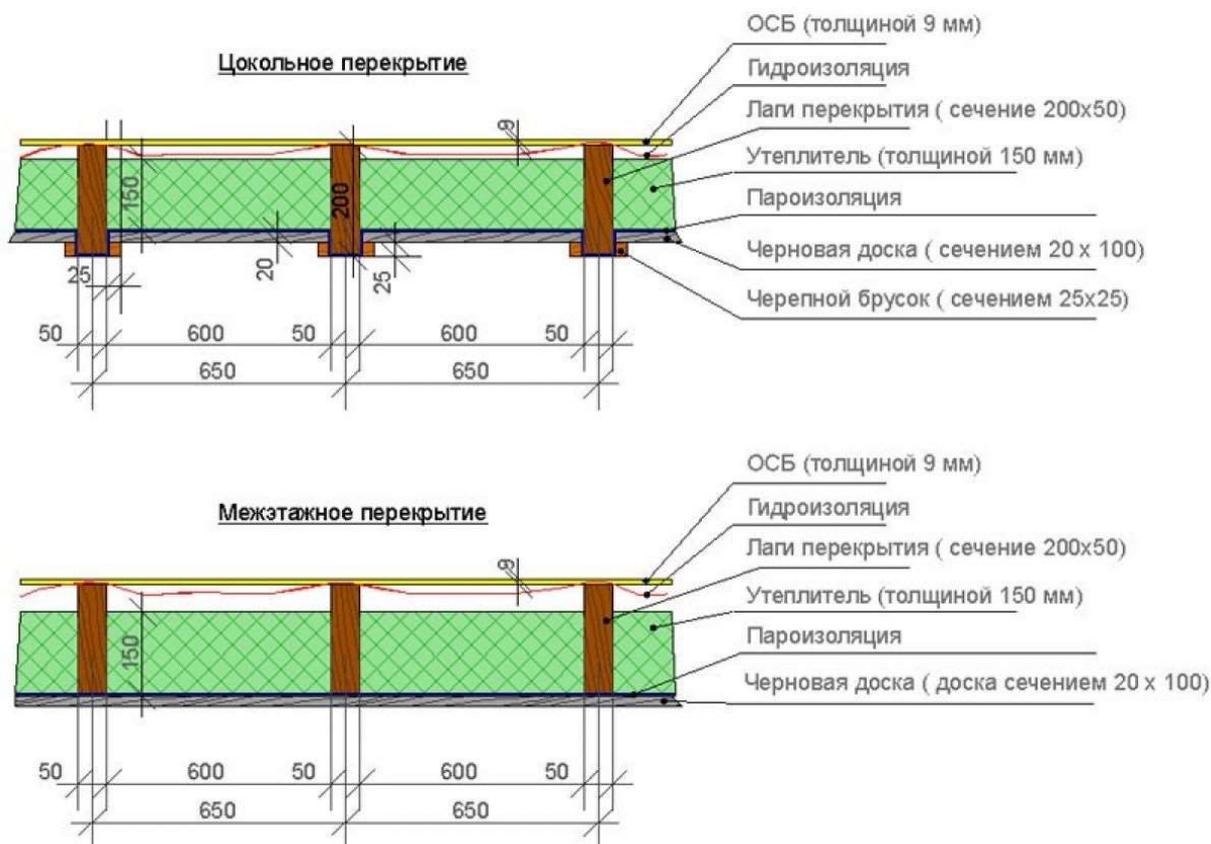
Междуэтажное и цокольное перекрытие по деревянным балкам
